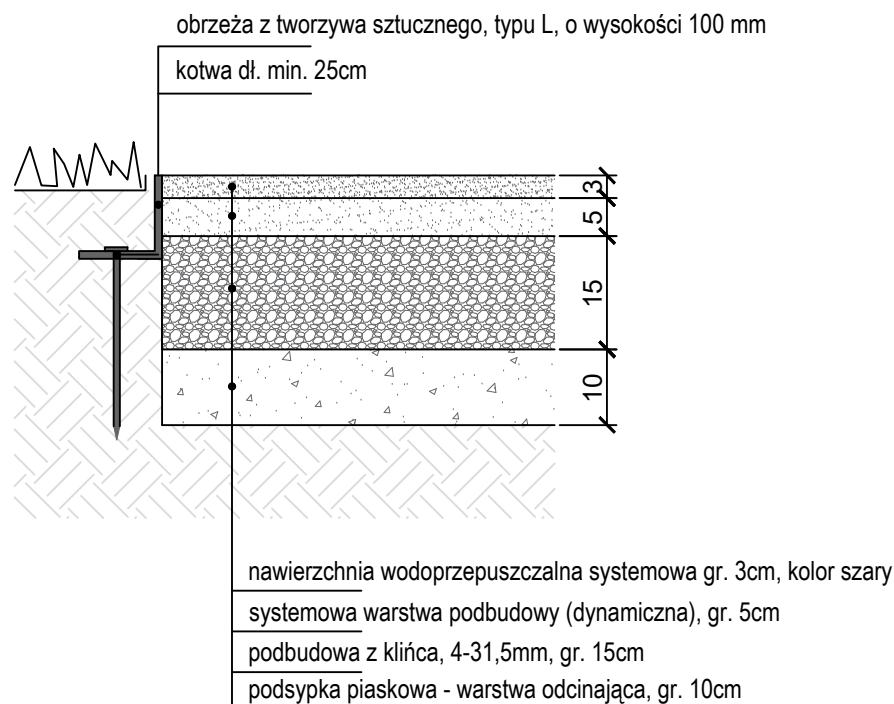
Projektowana nawierzchnia – konstrukcja
